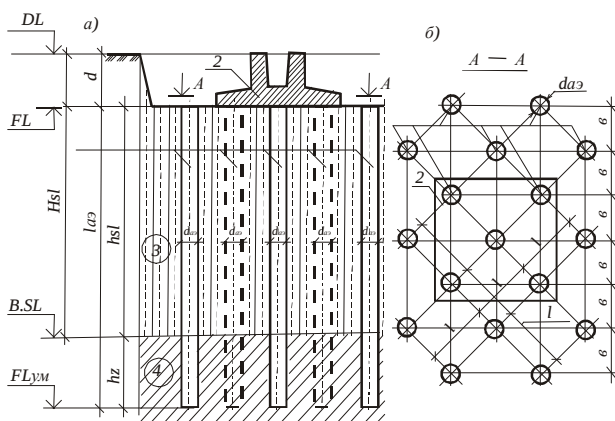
Схема армирования просадочного грунта основания: а - разрез; б - план
